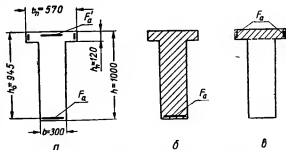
Поперечное сечение балки: а — поперечное сечение балки, б — сечение, учитываемое при расчете на вертикальные нагрузки; в — сечение, учитываемое при расчете на горизонтальные нагрузки.
